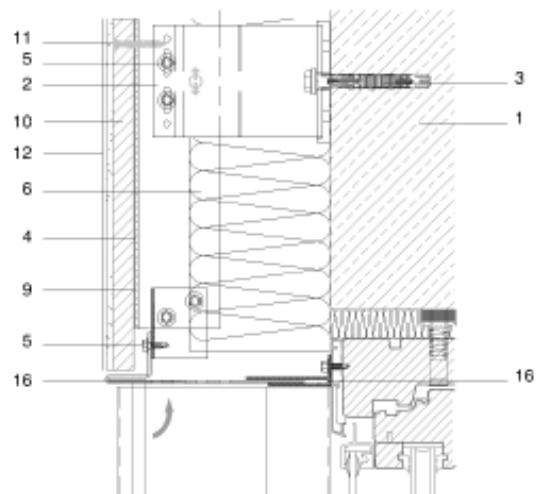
Detalhe construtivo de lintel com perfil metálico [78].
